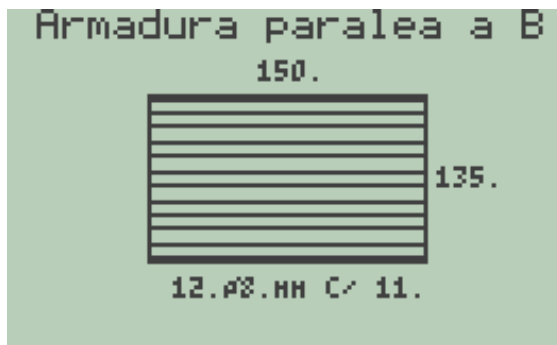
Sapata isolada - Detalhe da sapata - Armadura paralela a B.
